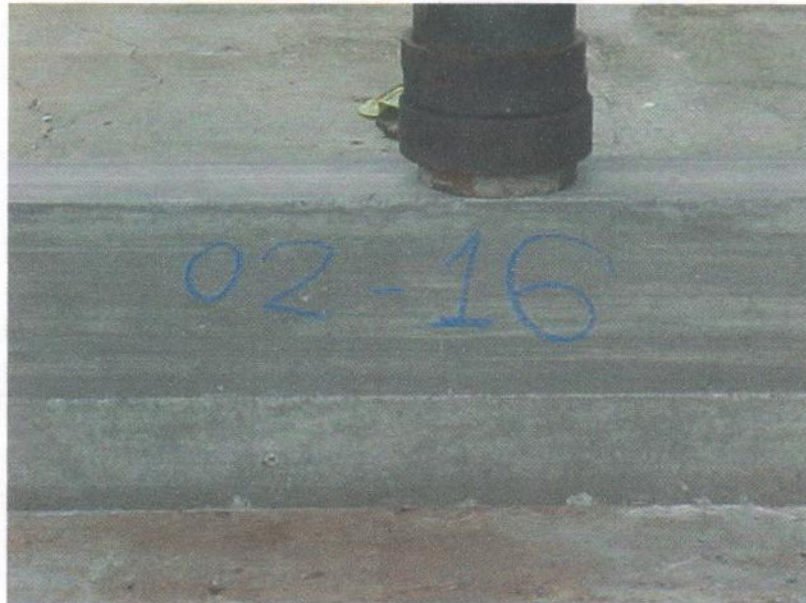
Posicionamento da viga no início do ensaio (Amostra 02 – concreto Fck 16Mpa).
